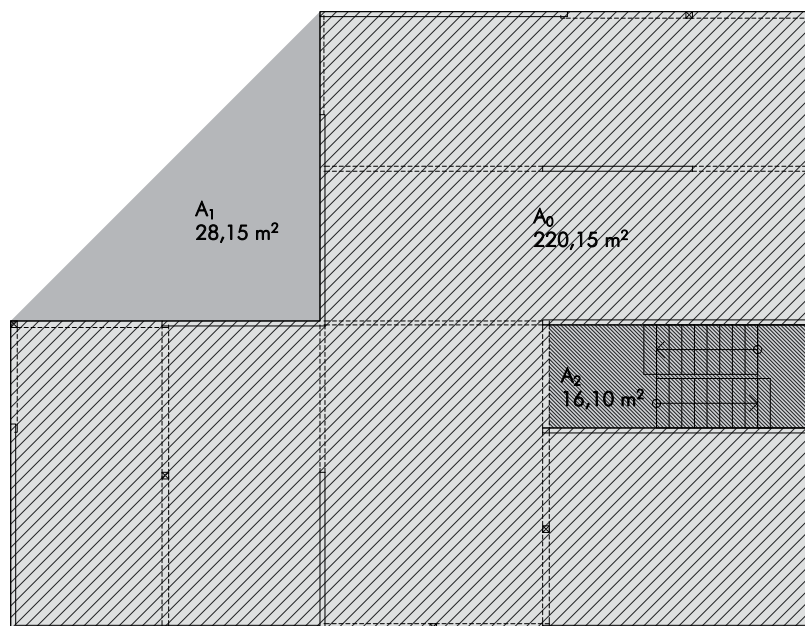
Flächeninhalte der Rück- und Einsprünge im Grundriss
